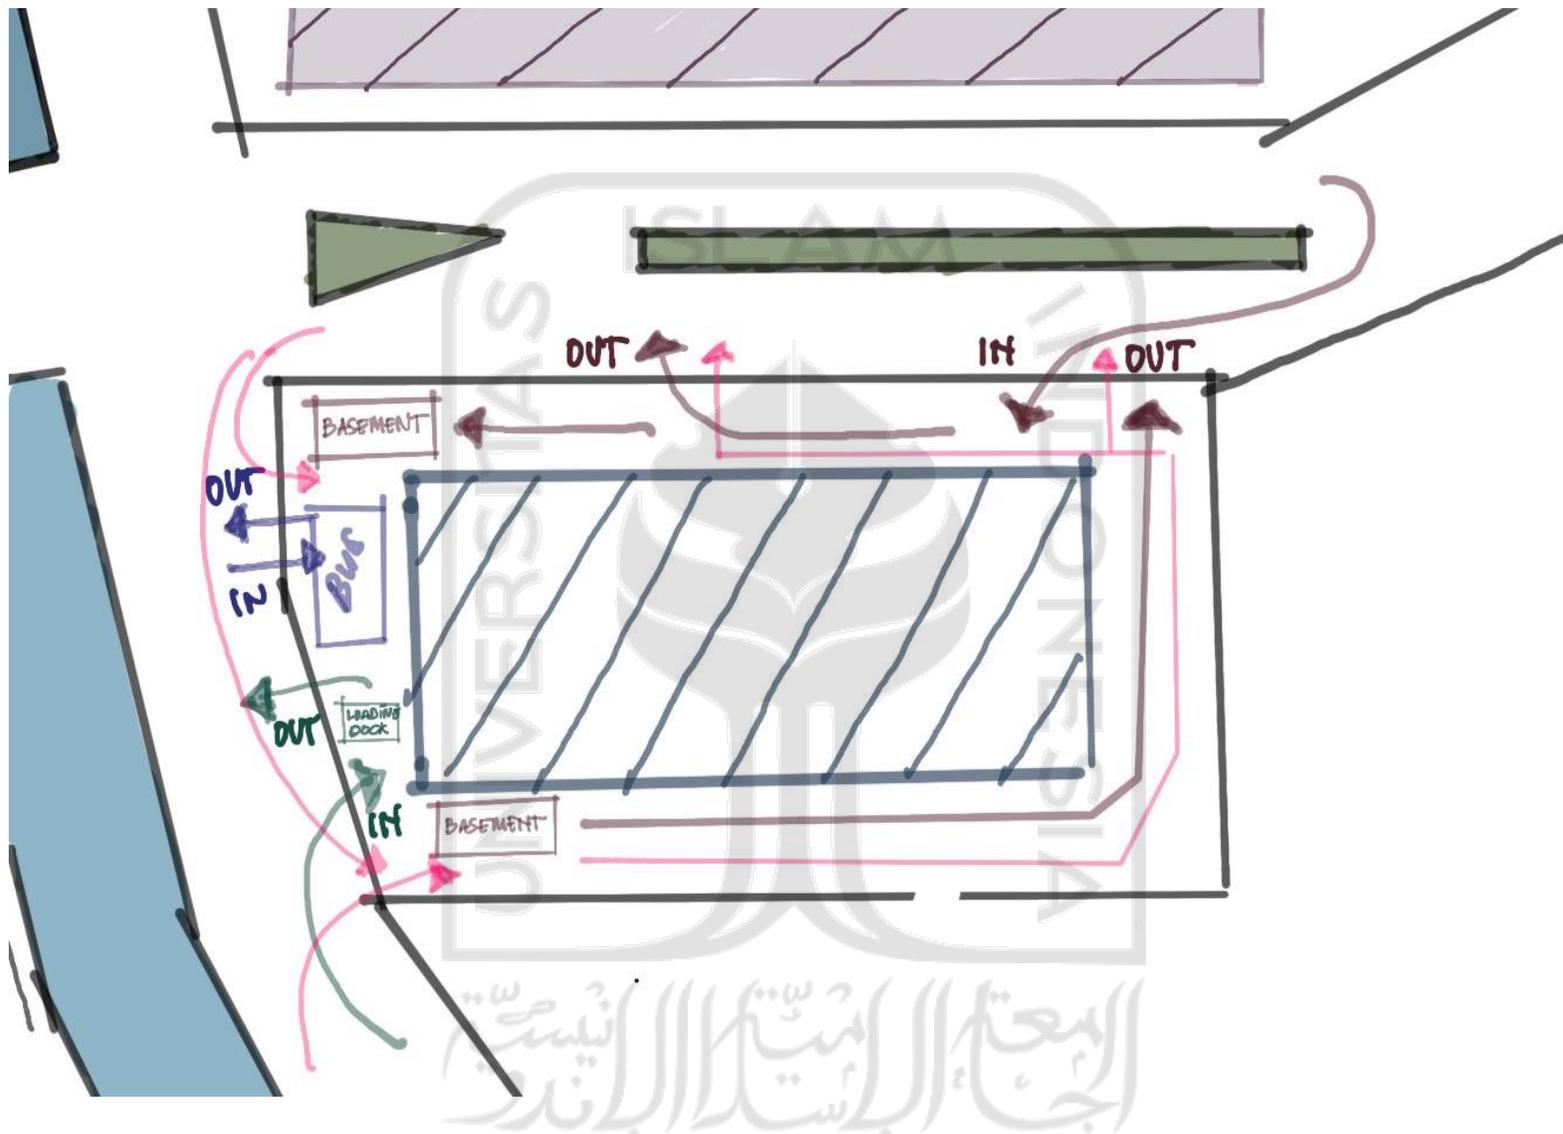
Sirkulasi Alur Gerak Ruang
